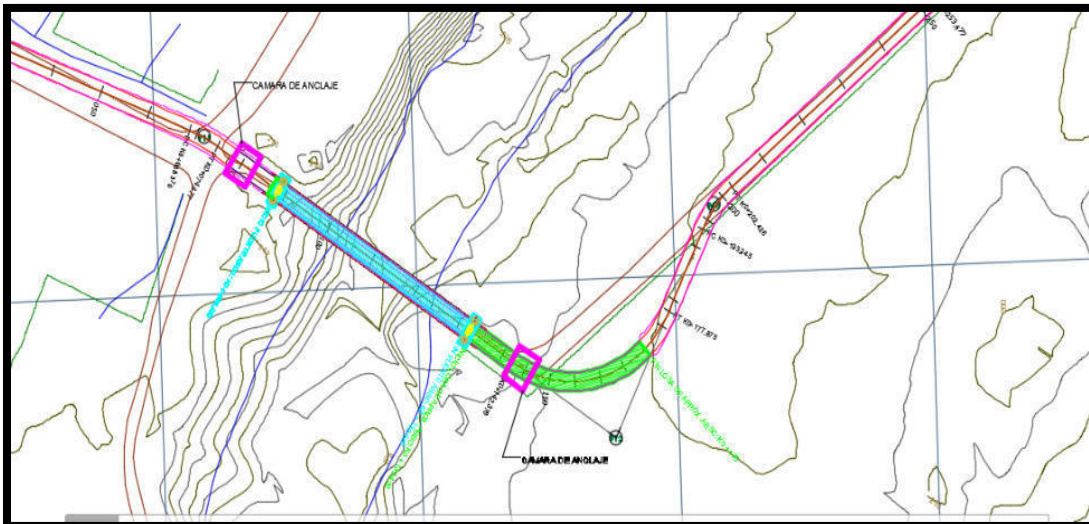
"plano de ubicación final del puente vehicular sobre el rio El Afilador"
